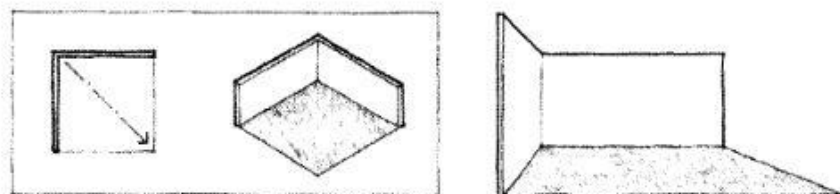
Elemen Vertikal : Bidang Vertikal Tunggal
